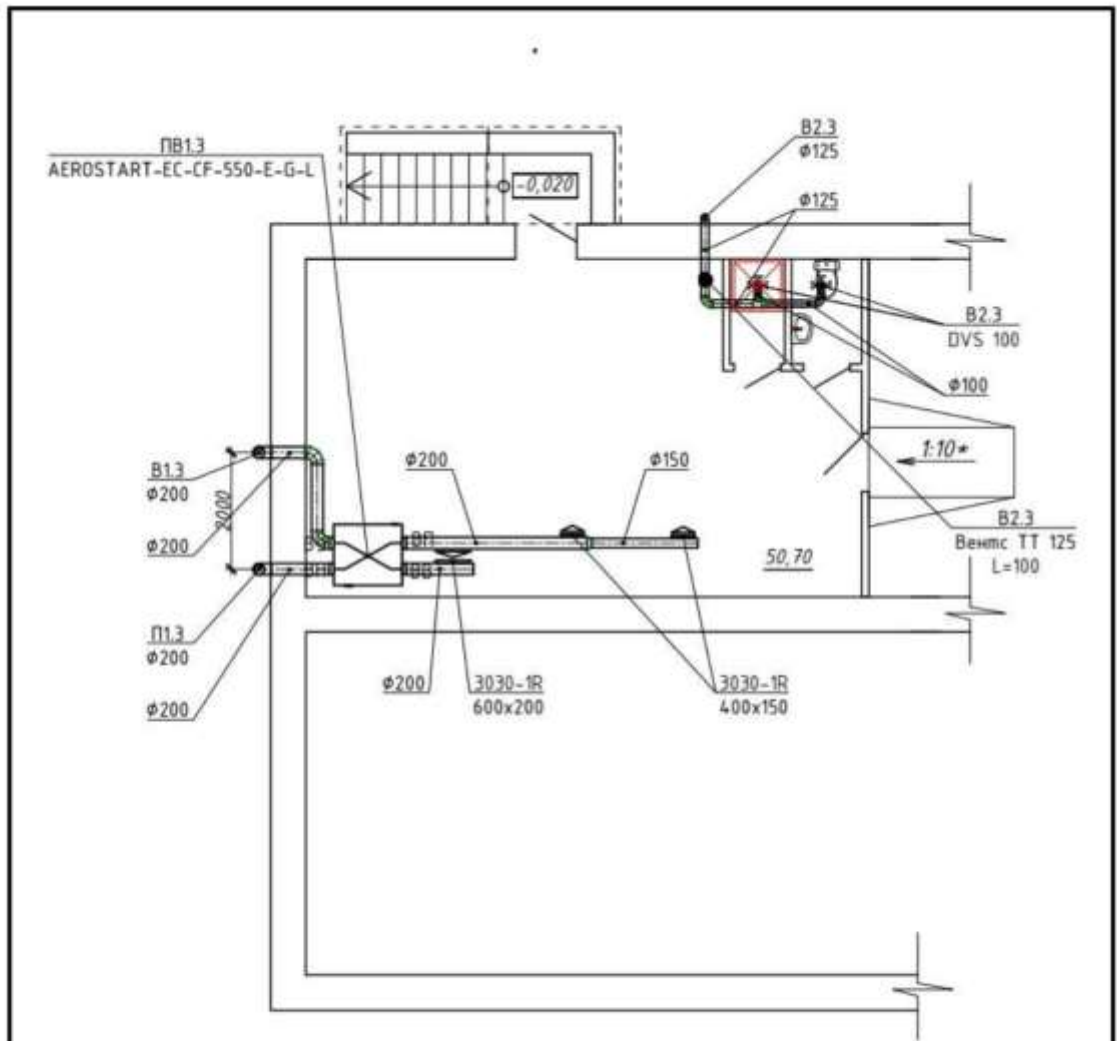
План укриття №3. Схеми системи ПВ1.3, В2.3.
